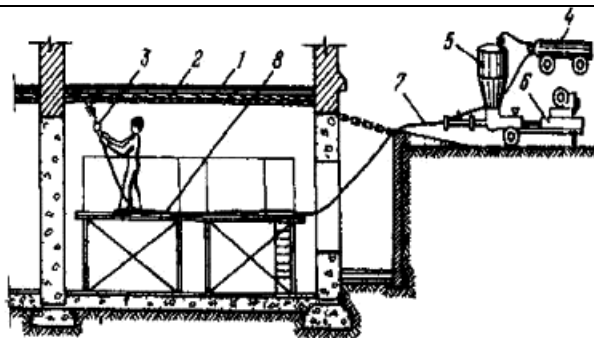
Принципиальная схема нанесения мелкозернистого бетона пневмоспособом при усилении железобетонных монолитных перекрытий
